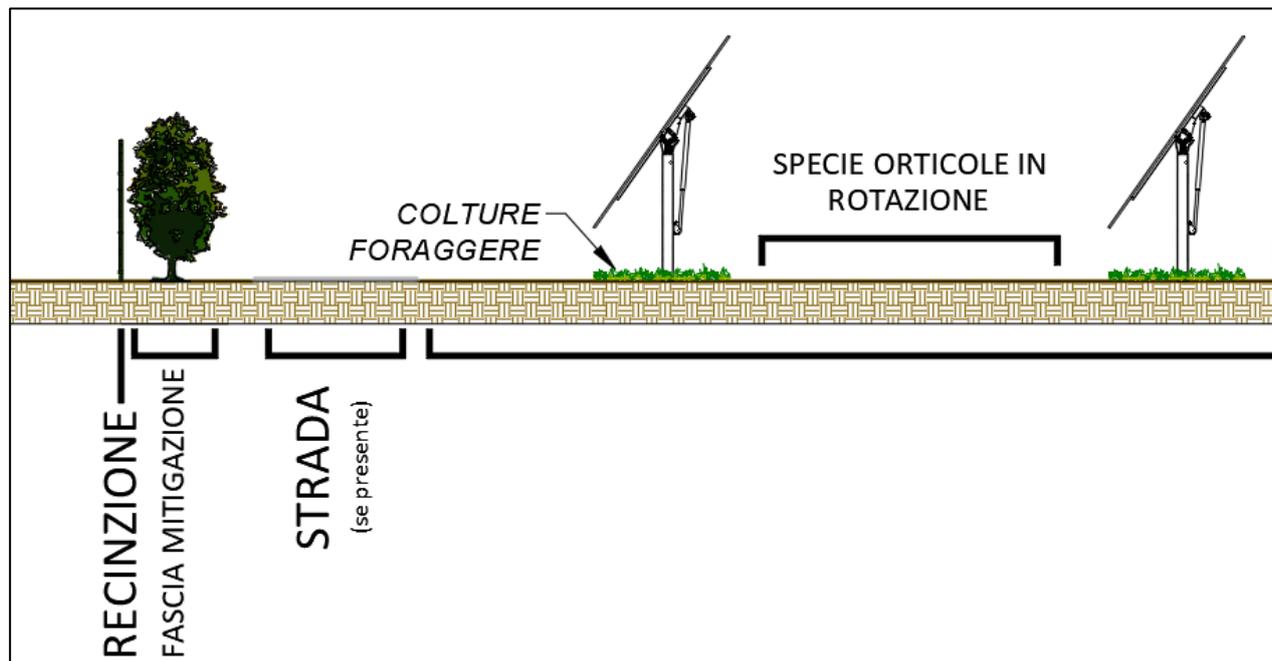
Sezione della zona perimetrale dell'area d'impianto in cui sono presenti: recinzione, fascia di mitigazione (uliveto), aree interfila con specie orticole in rotazione e strutture tracker
